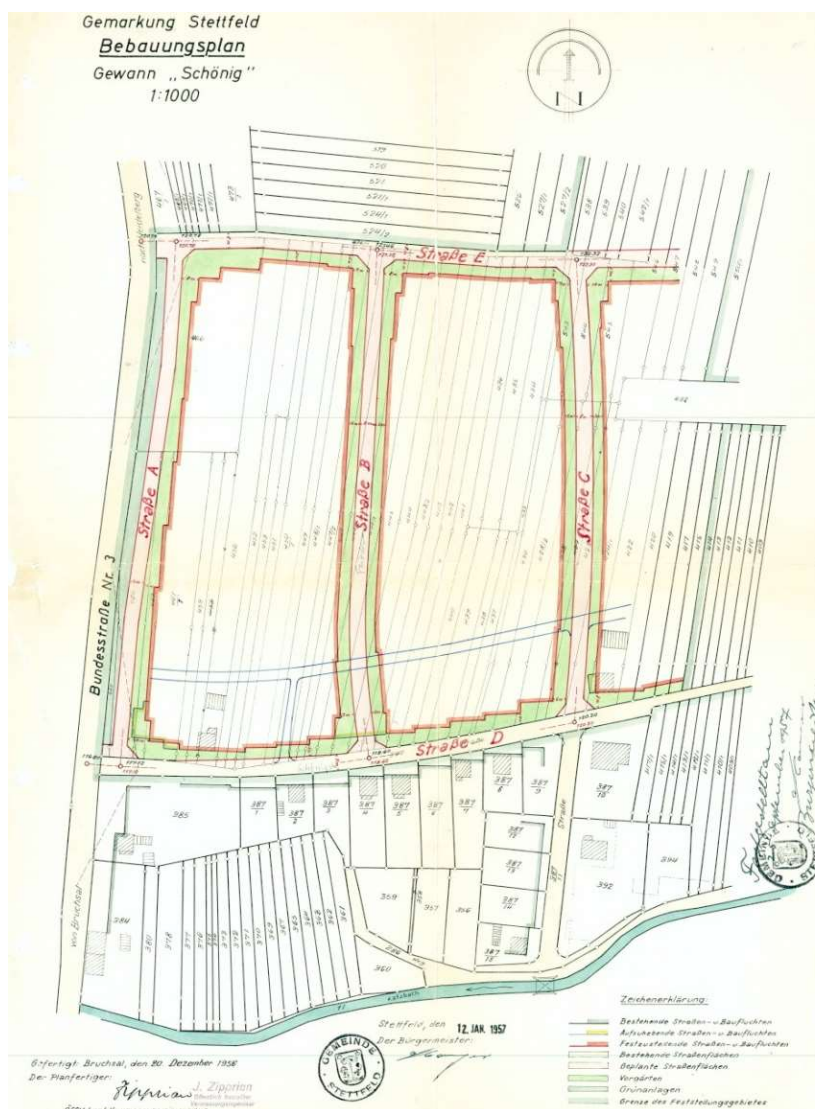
Baufluchtenplan „Bebauungsplan Schöning“, 1957
